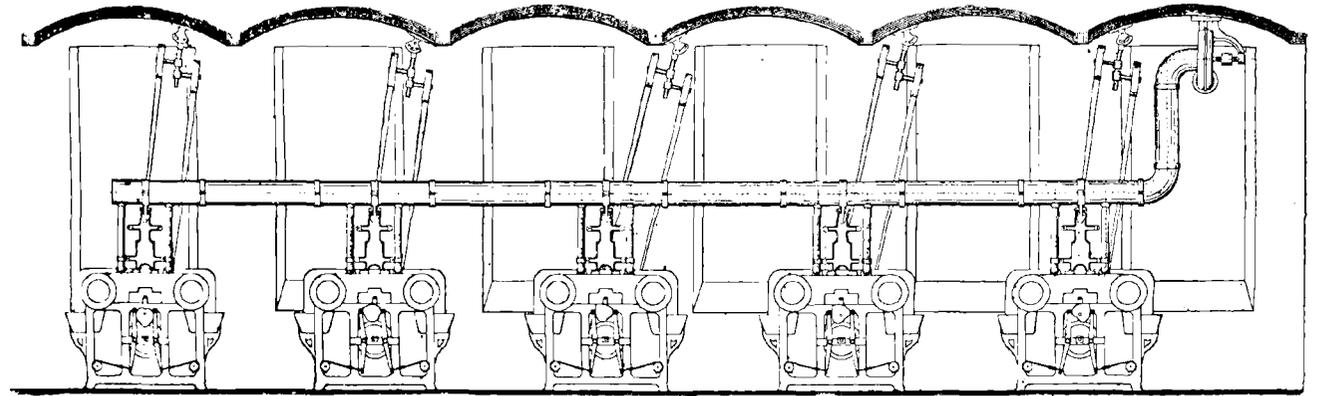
Coupe en élévation suivant la longueur de la salle.
